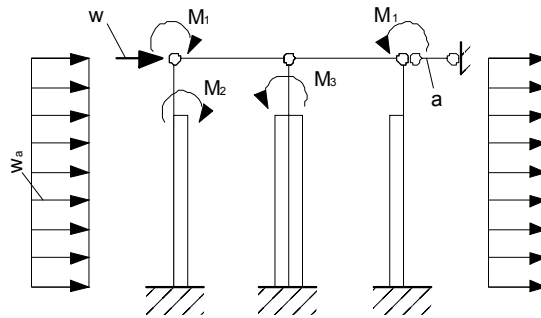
Розрахункова схема одноповерхової двопрольотної промислової будівлі
